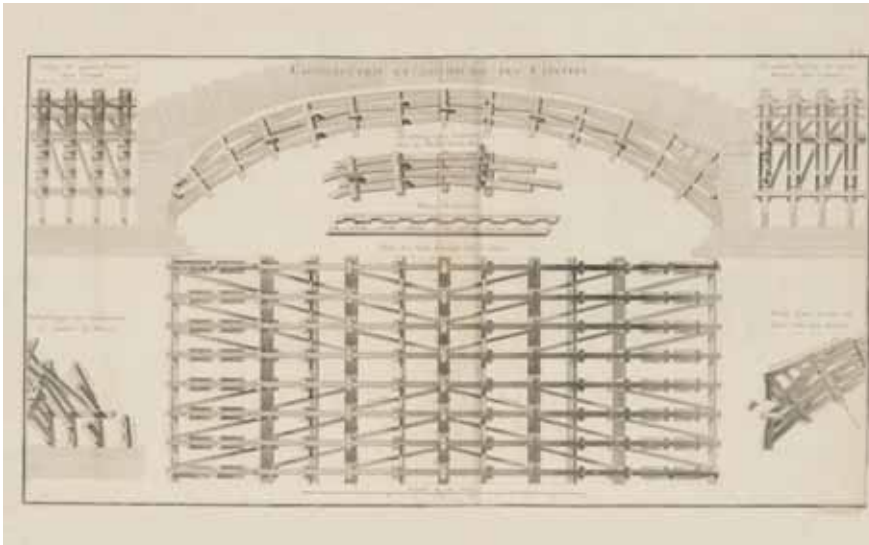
Cimbra flexible del puente de Neuilly (Perronet) [6]
